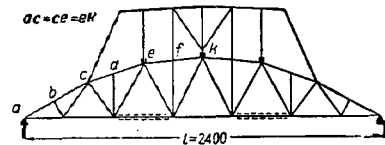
Схема многоугольной фермы с переломами в узлах стоек
